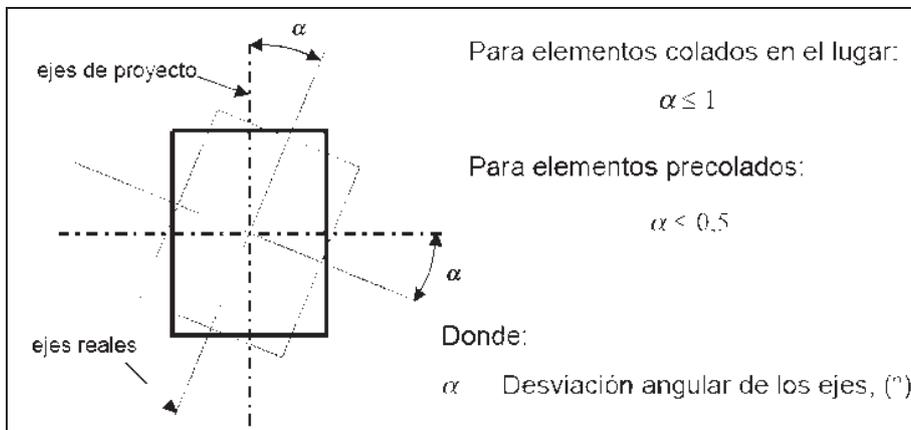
Tolerancia para la desviación angular de trabes o columnas [16].
